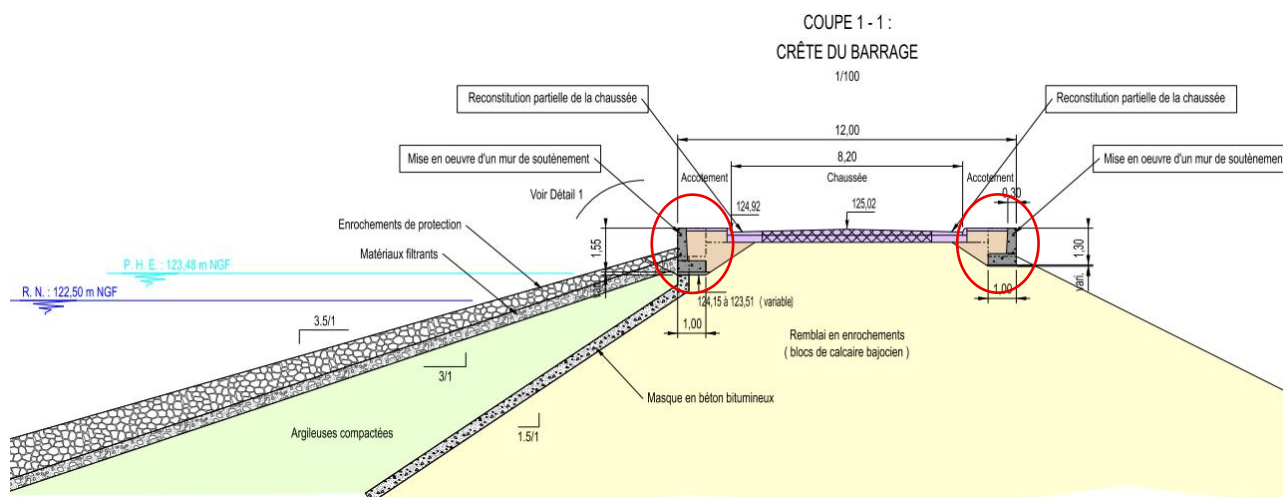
Exemple de revanche (rond rouge) sur barrage en remblai avec route (plan stade Projet – ISL 2025)
